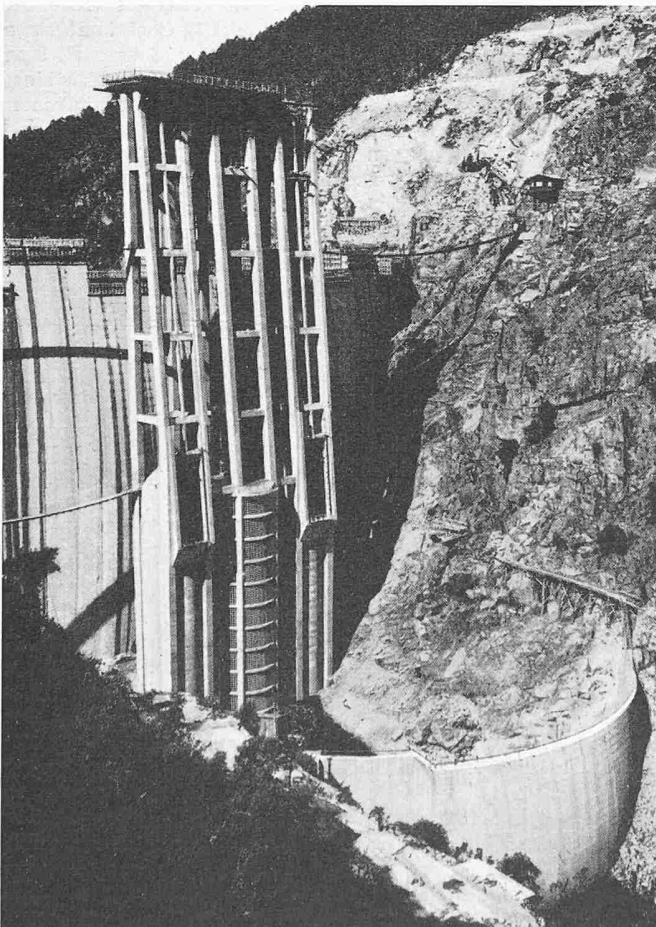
Dreifacher Turm für Wasserfassungen und Grundablass im Aufbau. Vorne Baugrubenabschluss
